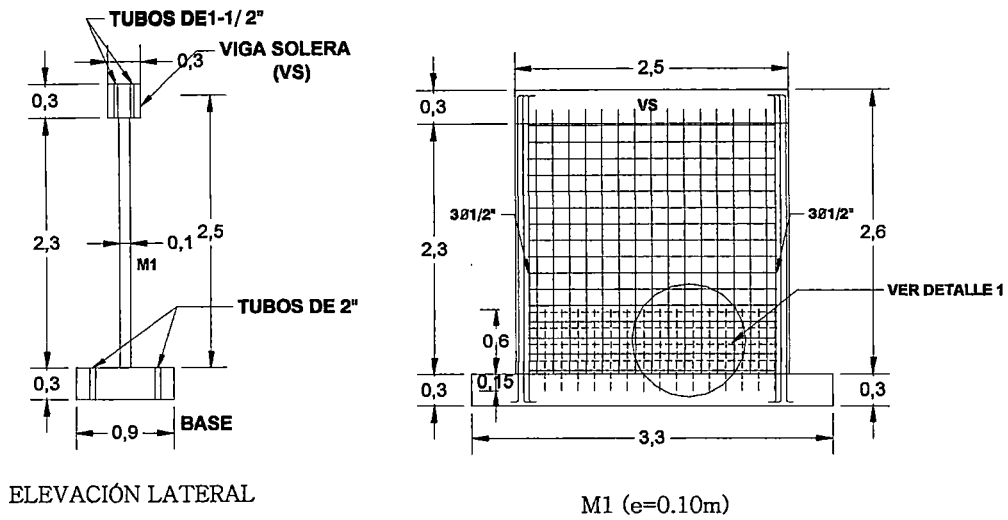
Geometría y refuerzo de los muros 01 y 02.
